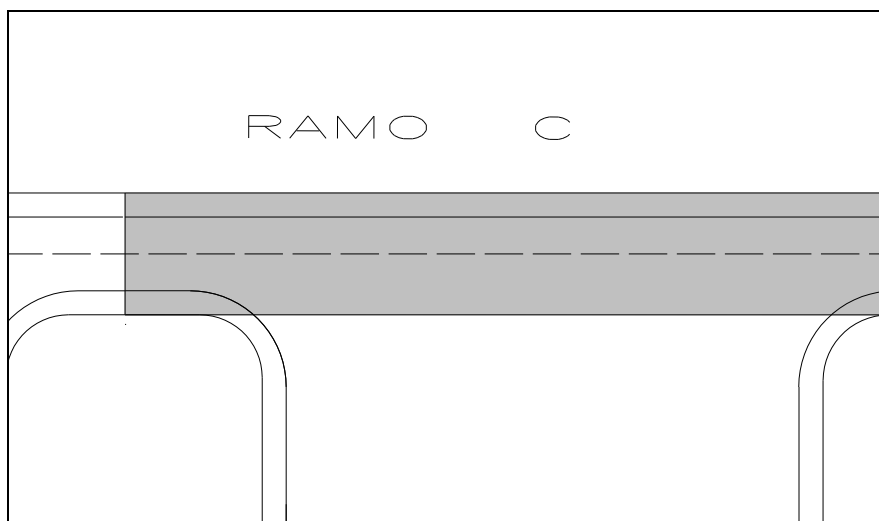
Complementação da pavimentação da pista de táxi do Ramo C
